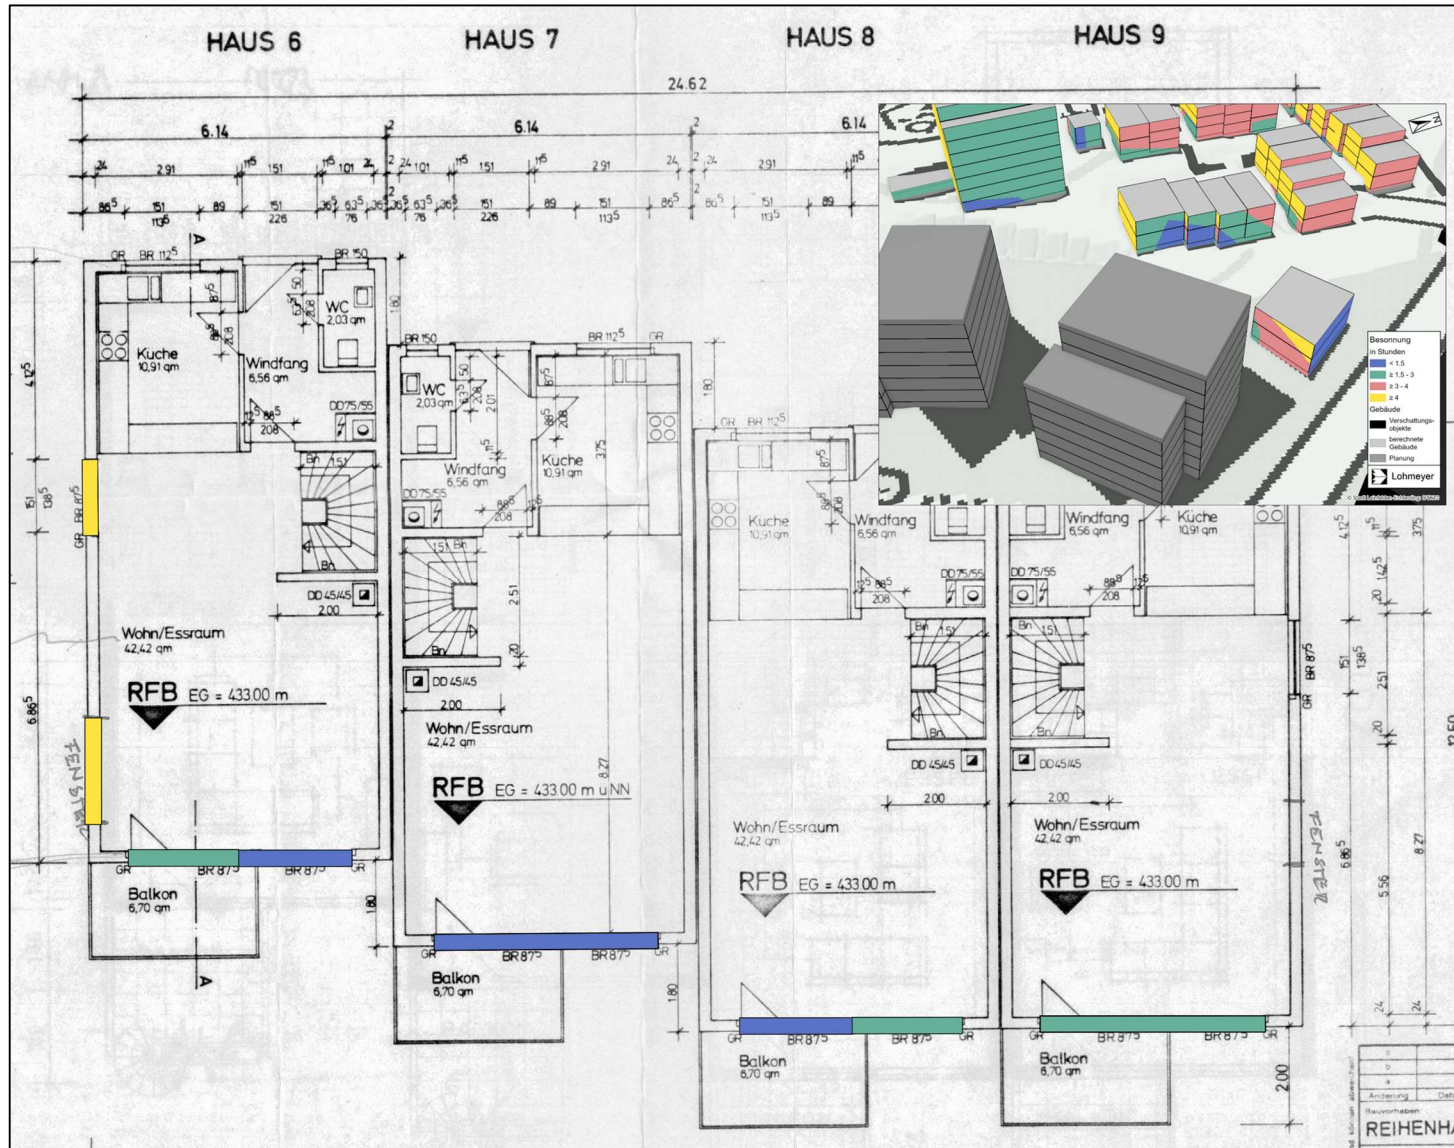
Grundrisse der Kapfstraße 42 bis 48 im Erdgeschoss und direkte Besonnungsdauer an den zur Planung zugewandten Fenstern
